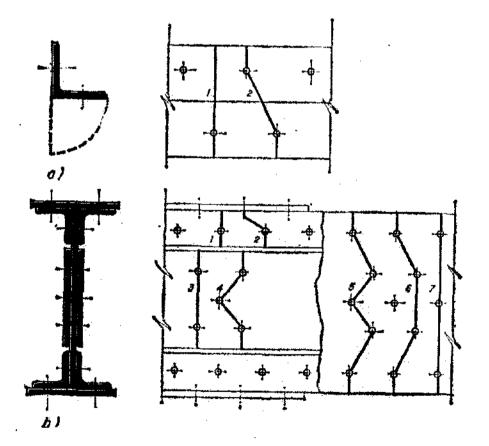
Líneas rectas o quebradas para clegir la sección recta de área mínima
